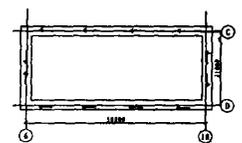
游泳池底板脚及侧板混凝土浇筑顺序示意图
